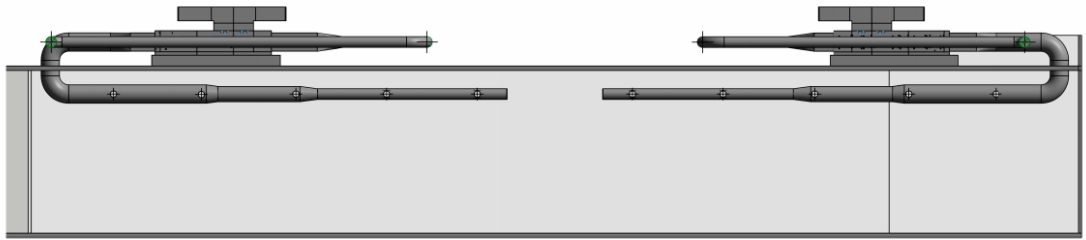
Corte Longitudinal das condutas de insuflação.
